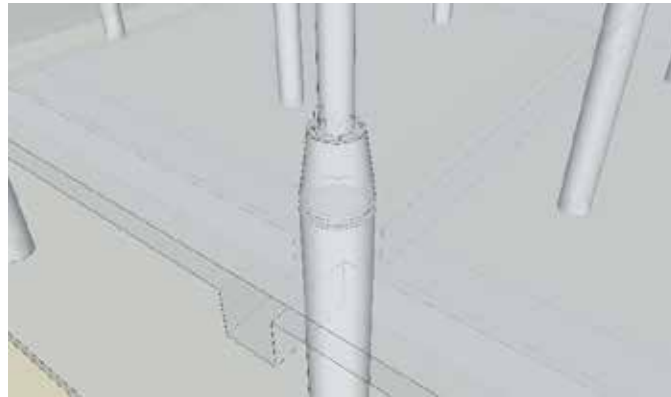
Detalle de anclaje de columnas de acero a columna de concreto. (2016)
